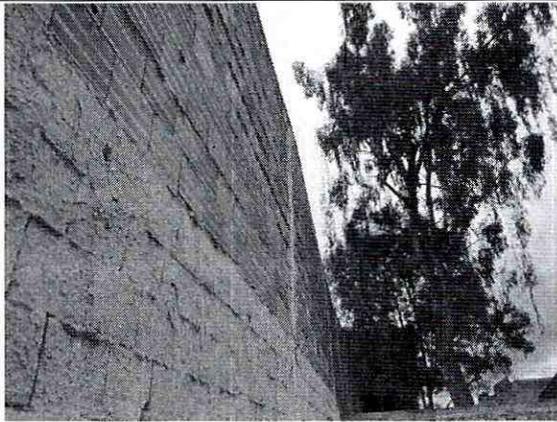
Ligera pérdida de verticalidad, extremo oriental.
